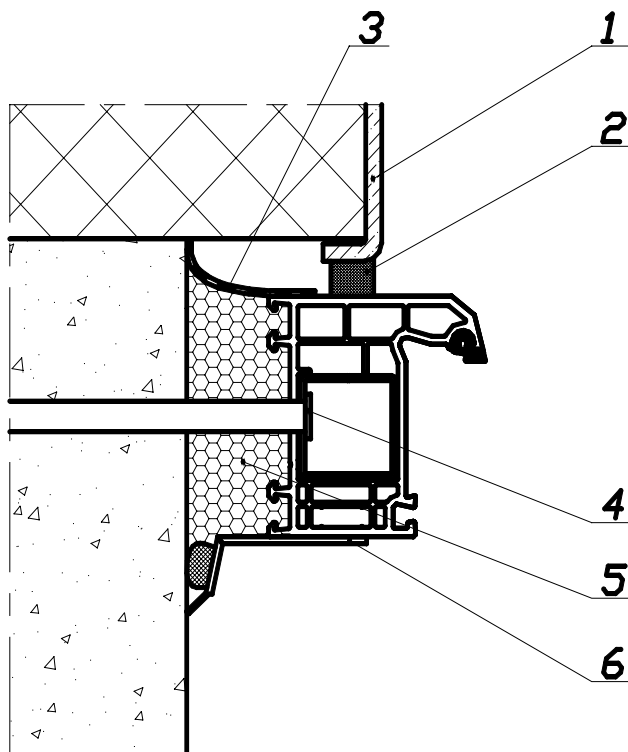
Узел бокового примыкания оконного блока к проему стены из бетона с наружным утеплением фасада и установкой внутреннего декоративного нащельника с пароизоляционной системой.
